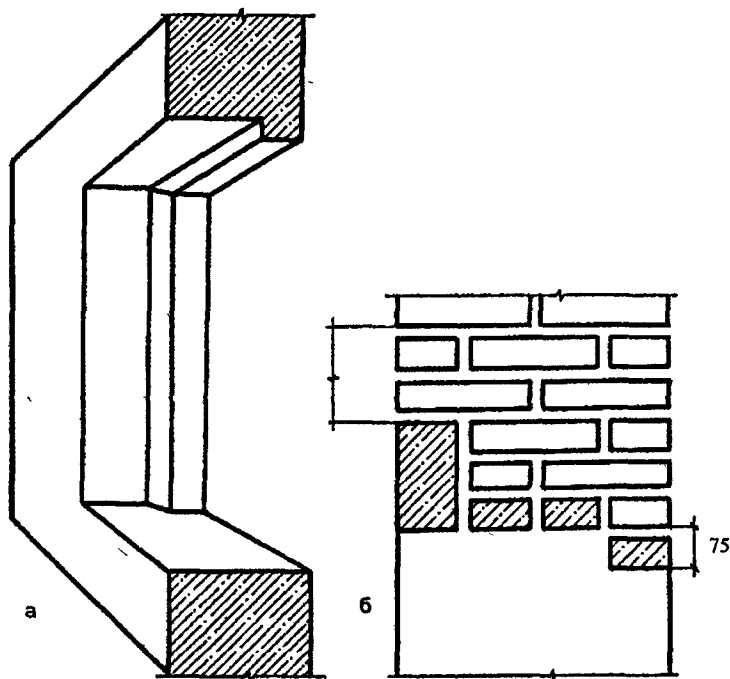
Проемы и перекрытия в кирпичных стенах:
